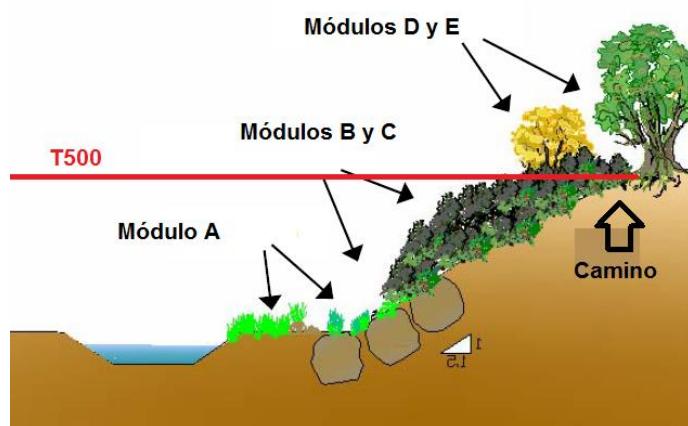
Esquema previsto de la situación de los módulos de plantación.
